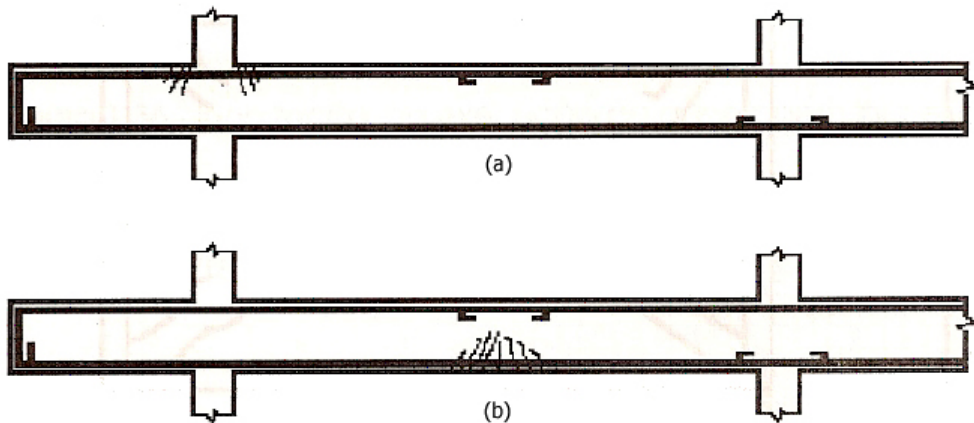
Fissuras de flexão (viga super-armada) (IPR Publicação, 709 – 2004)
